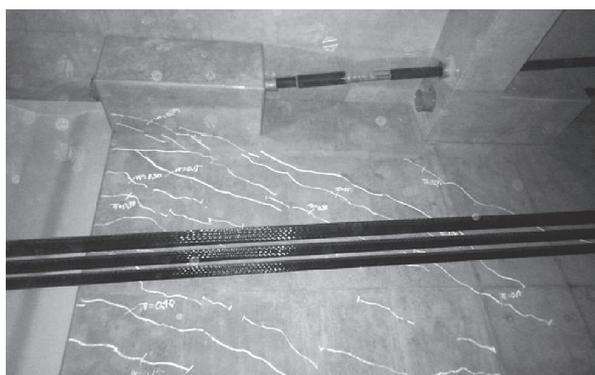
ウェブ内側のひび割れ状況(10BL)
